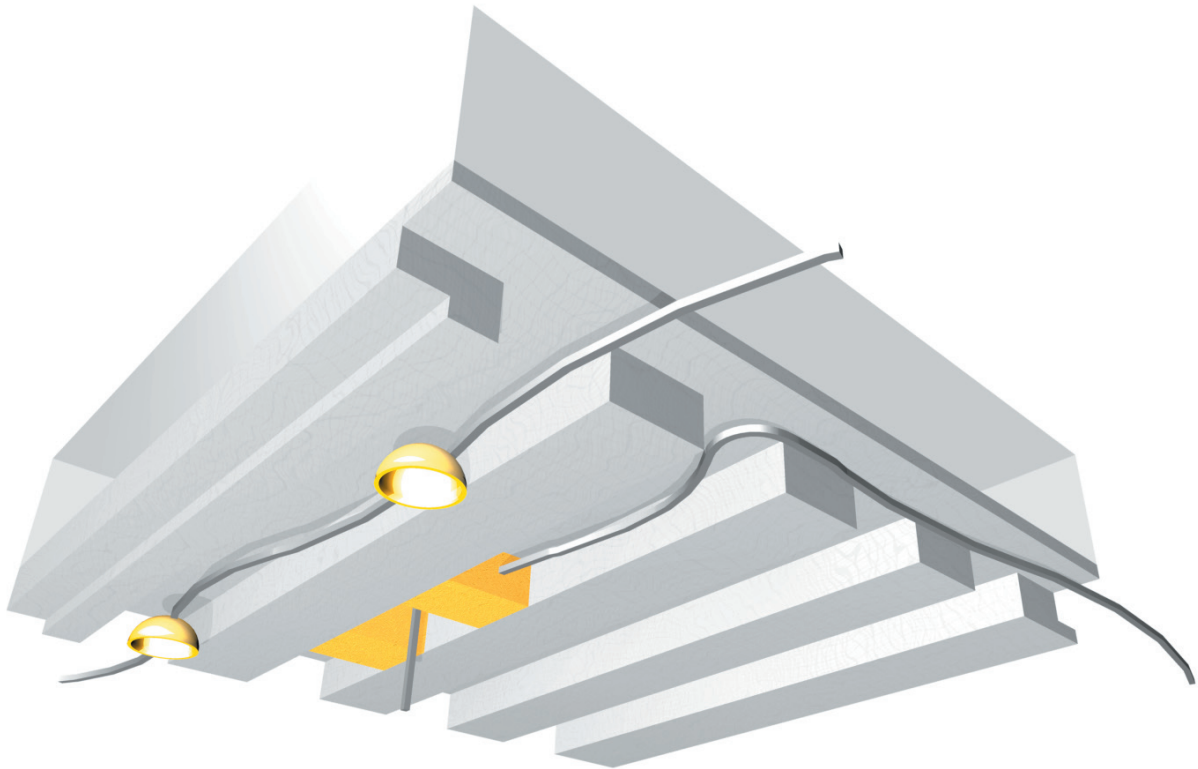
Elektroinstallation: Zur brandschutztechnischen Trennung des Deckenauslasses werden flexible Dämmklötze in den Hohlraum eingebracht. Diese schützen die Konstruktion vor einer Brandweiterleitung durch die Deckenöffnung und etwaige Hohlraum Dosen.
